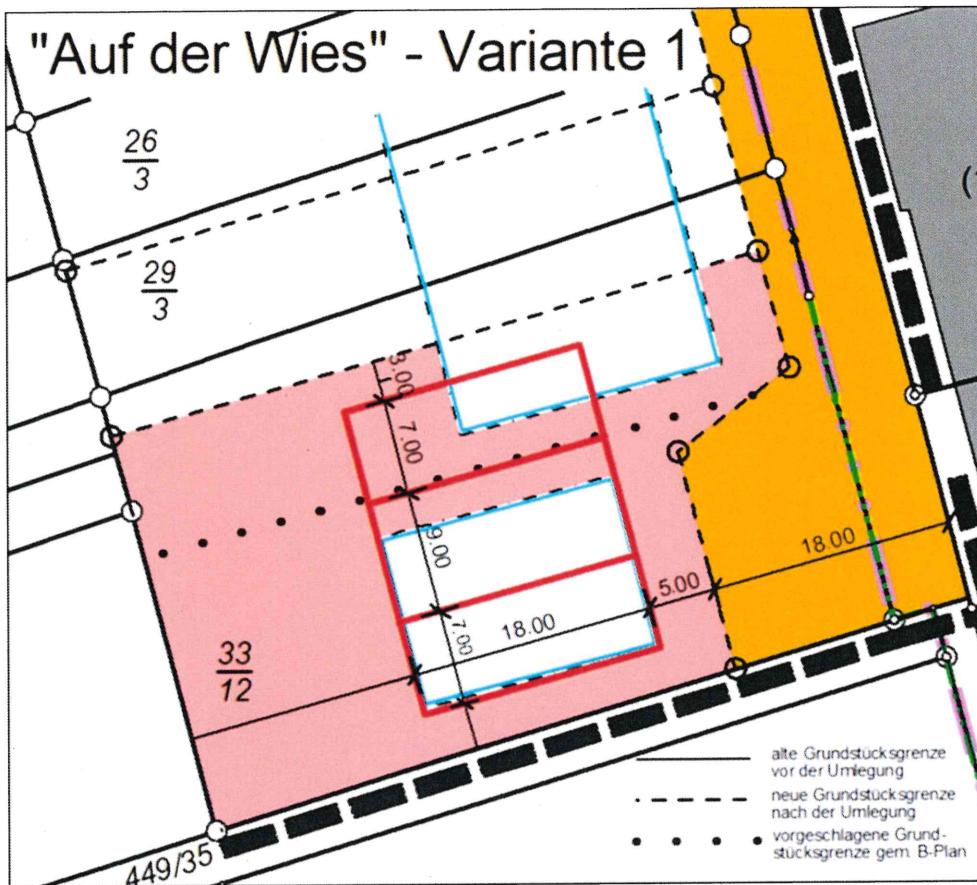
Überlagerung des wirksamen Bebauungsplanes mit der geplanten Neubebauung (Quelle: ZORA, LVGL, SLS-007/12)
